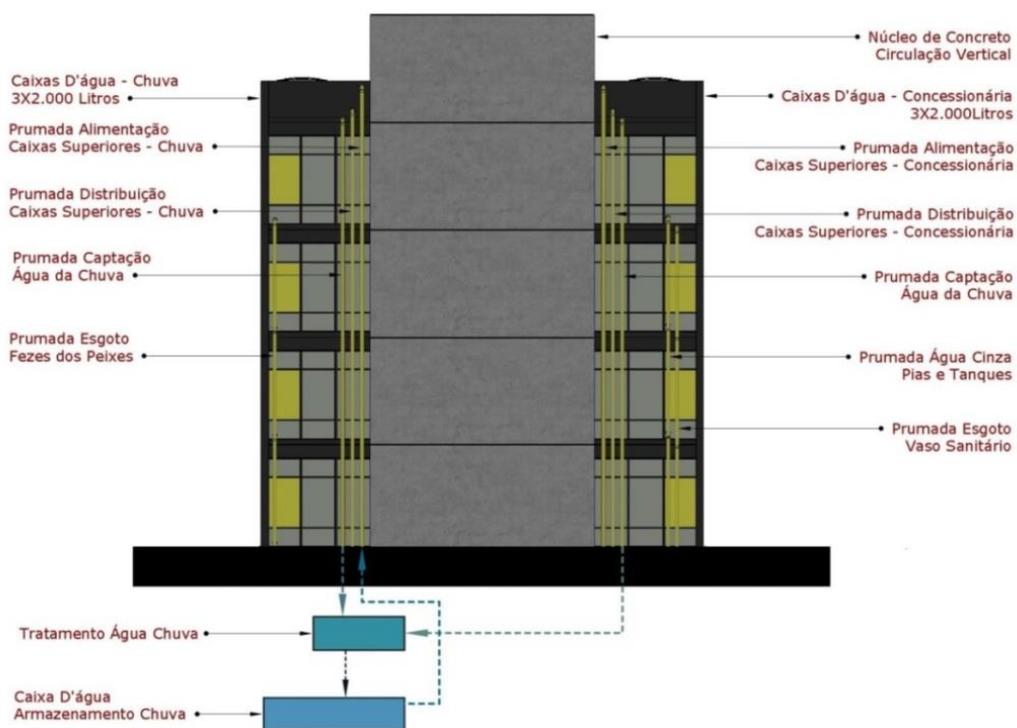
Esquema das instalações hidráulicas – fachada posterior
